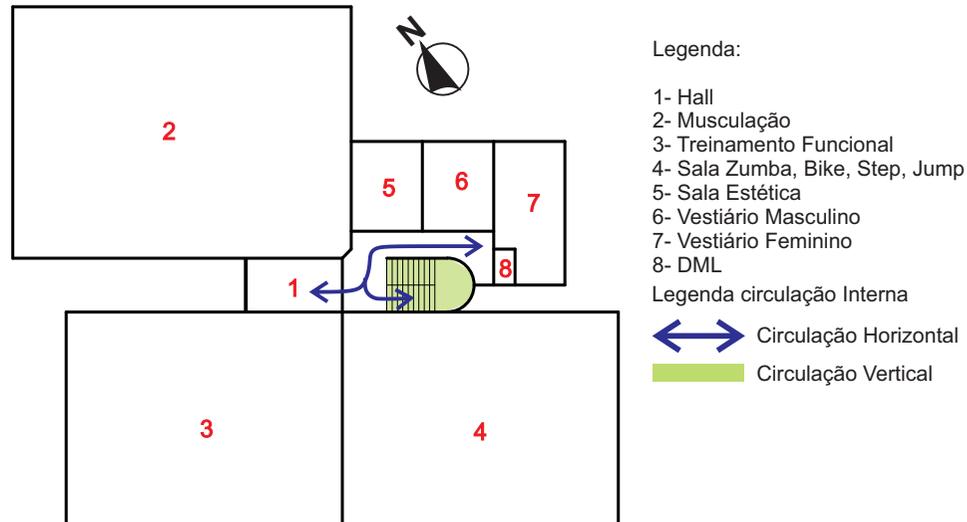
Planta Baixa esquemática segundo pavimento IAFF.
